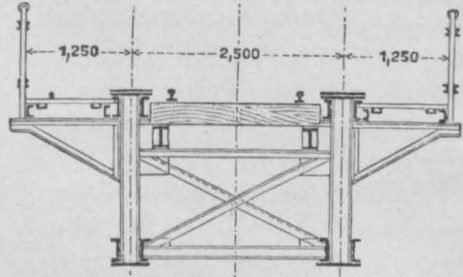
Bahn mitten oder halbversenkt, auf dem Bahngerippe lagernd. Geringere Bauhöhe.
